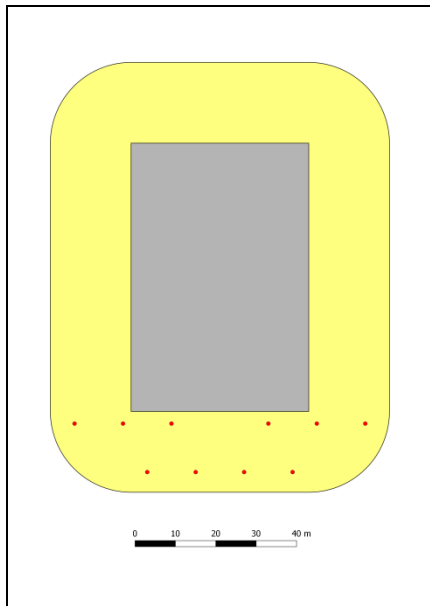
Modellbetrieb C, Standort Y, 70 kW-Wärmepumpe – Anordnung der oberflächennahen Erdwärmesonden
